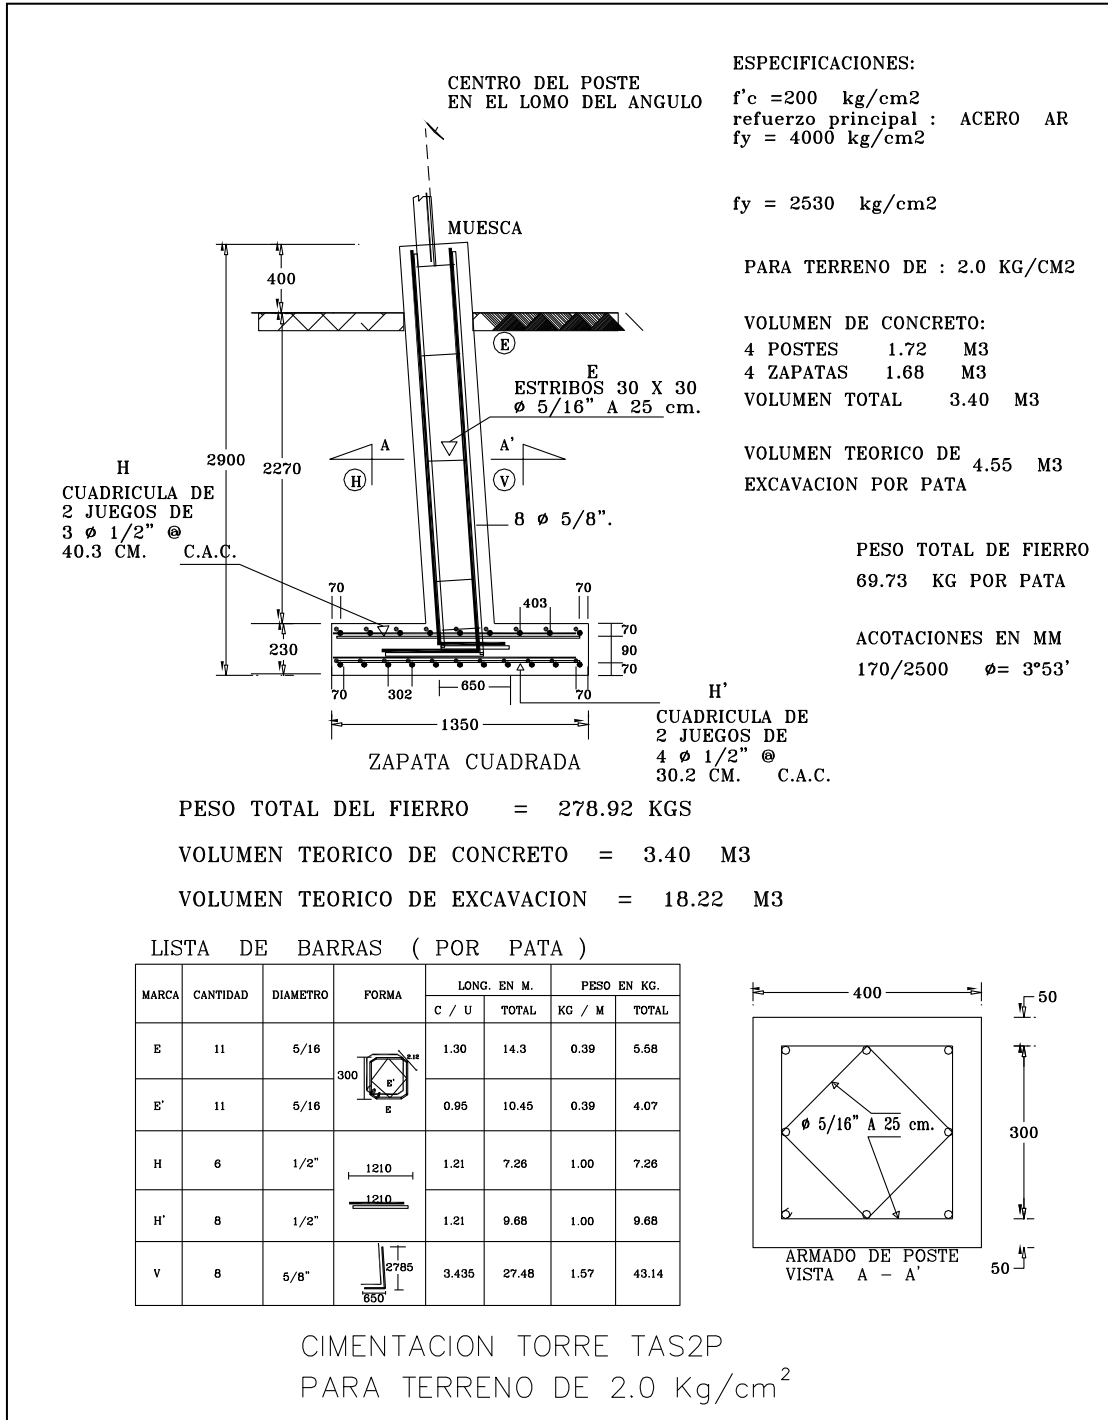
VISTA INTERIOR DE UNA CIMENTACIÓN
